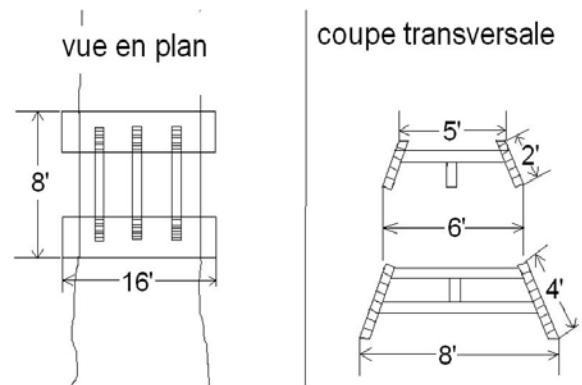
Plan de construction d'une palissade de bois double. La coupe transversale de gauche représente les deux sections du barrage construites séparément et assemblées dans le canal.
